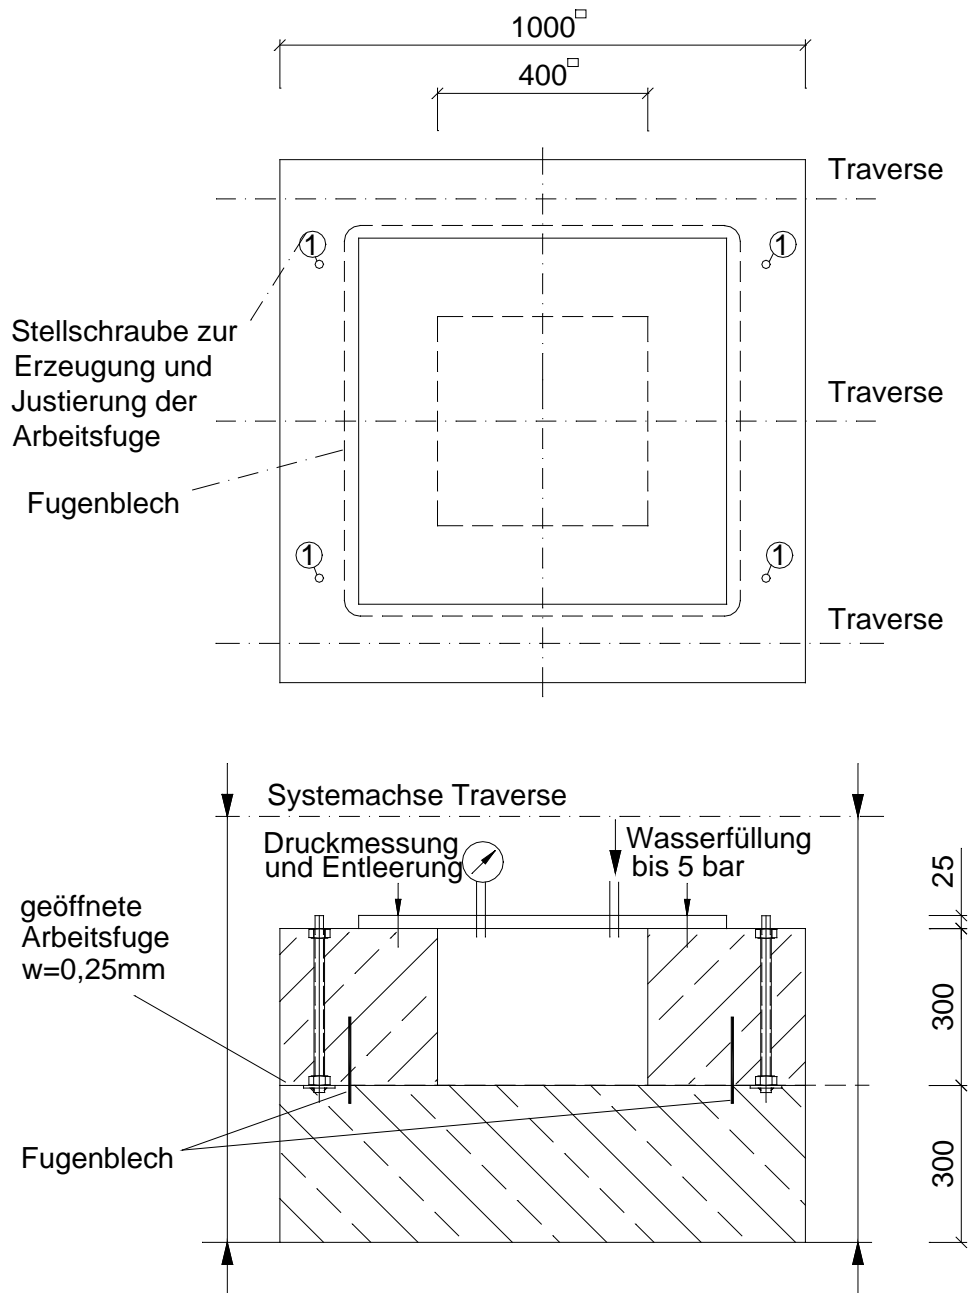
Variante B: Draufsicht und Schnitt des Prüfkörpers für Fugenbleche
